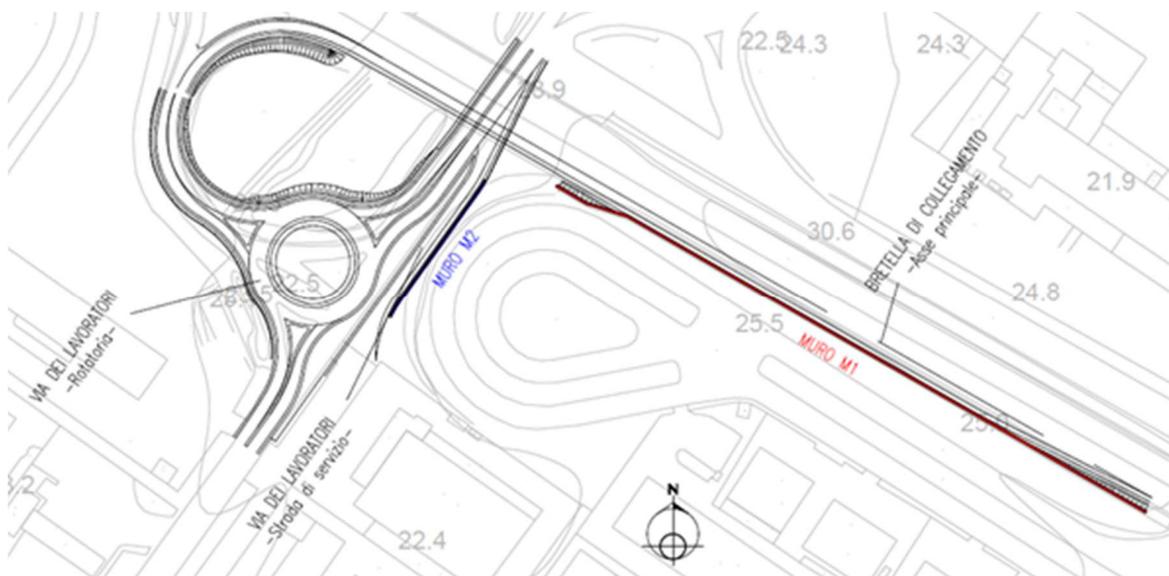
Inquadramento planimetrico mui Bretella di accesso alla SS16
